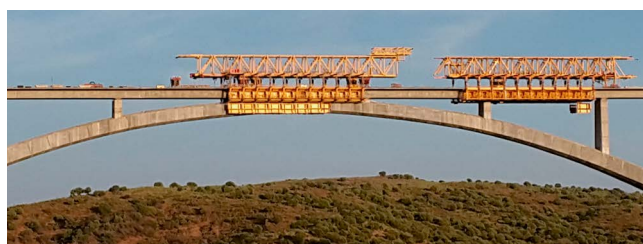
Fase 5 vano central. Retirada autocimbra sur.
